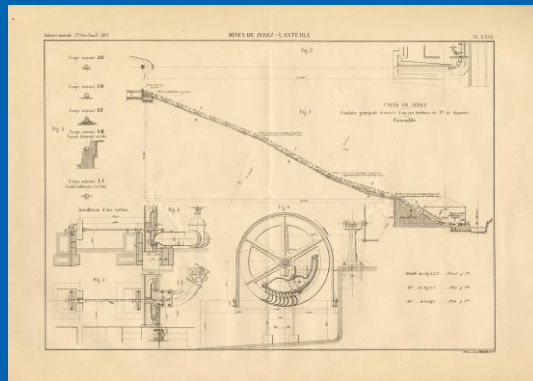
Plano detallado de la Central de aire comprimido año 1891: Cámara de carga, tubería forzada, casa de máquinas, y detalle de una turbina.
